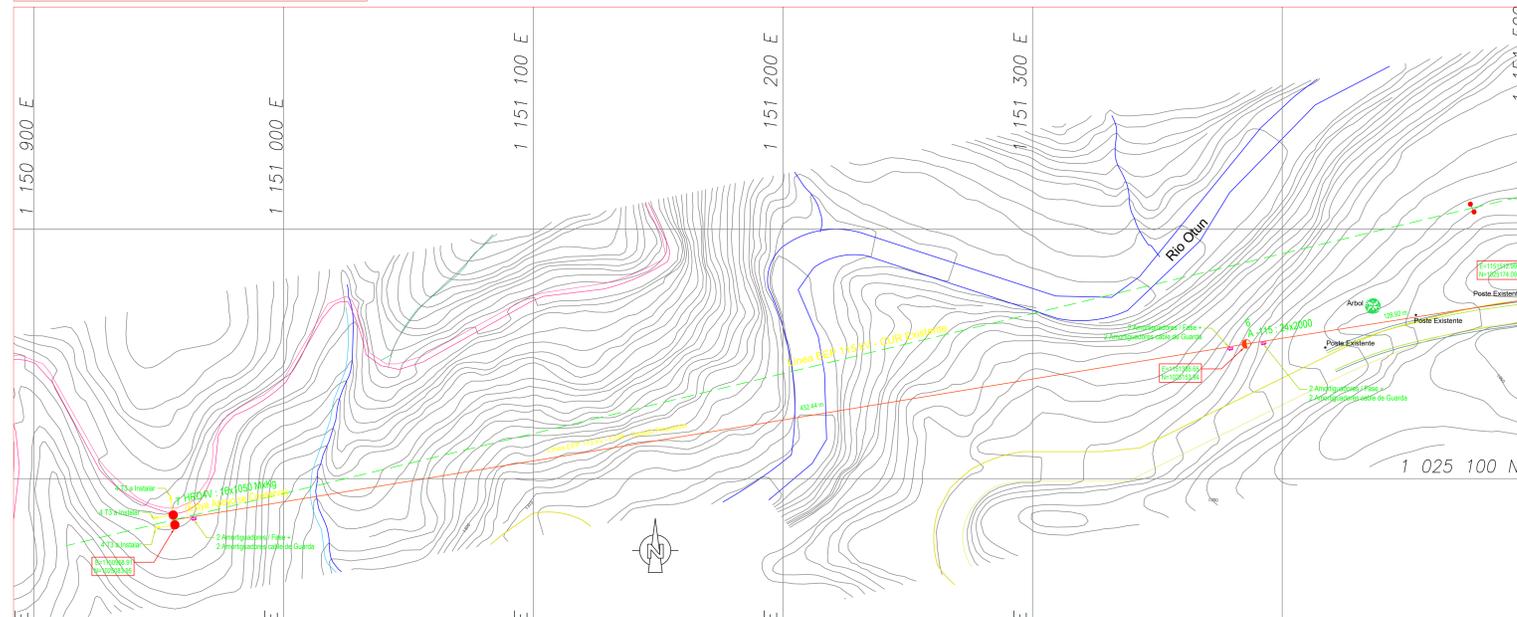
APOYO HRTD4 EXISTENTE
